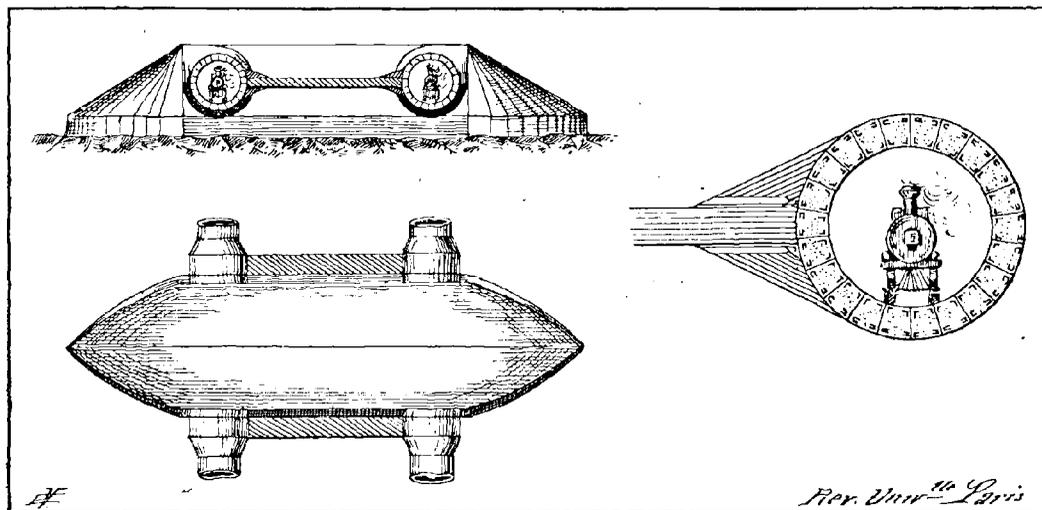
Coupe transversale et plan des tubes et d'une pile.
